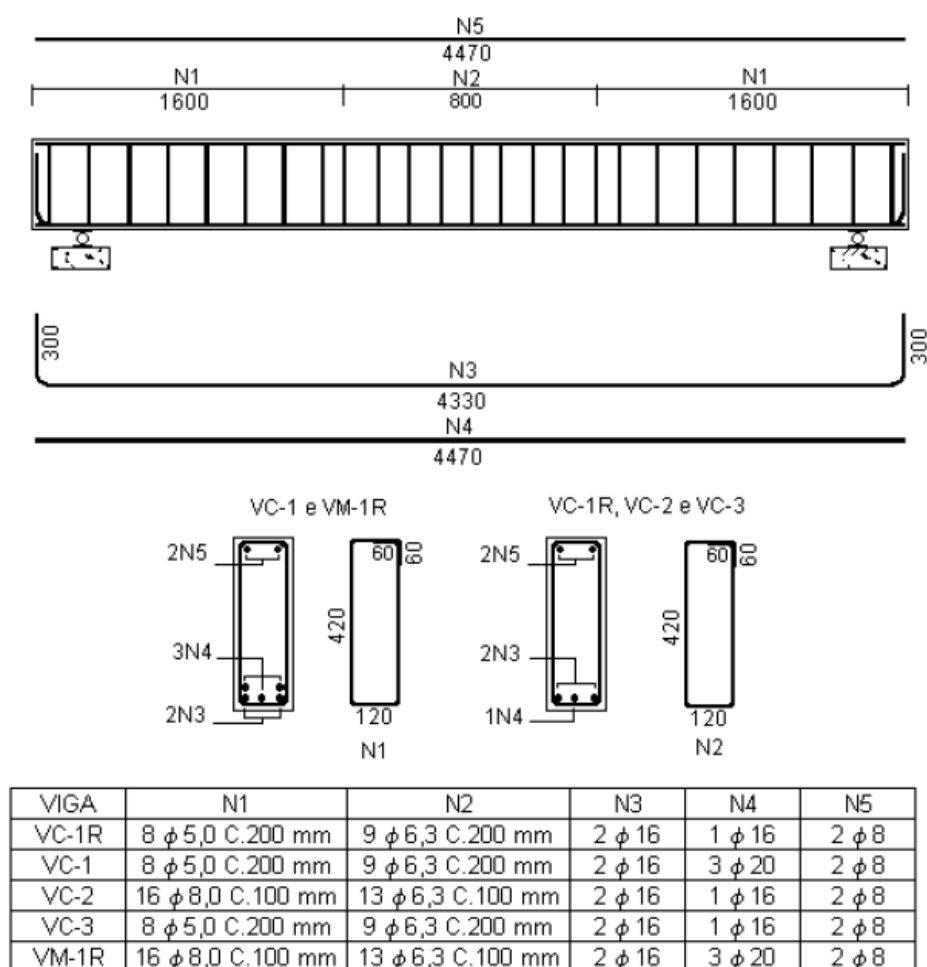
Detalhamento da armadura das vigas (Araújo, 2002)
